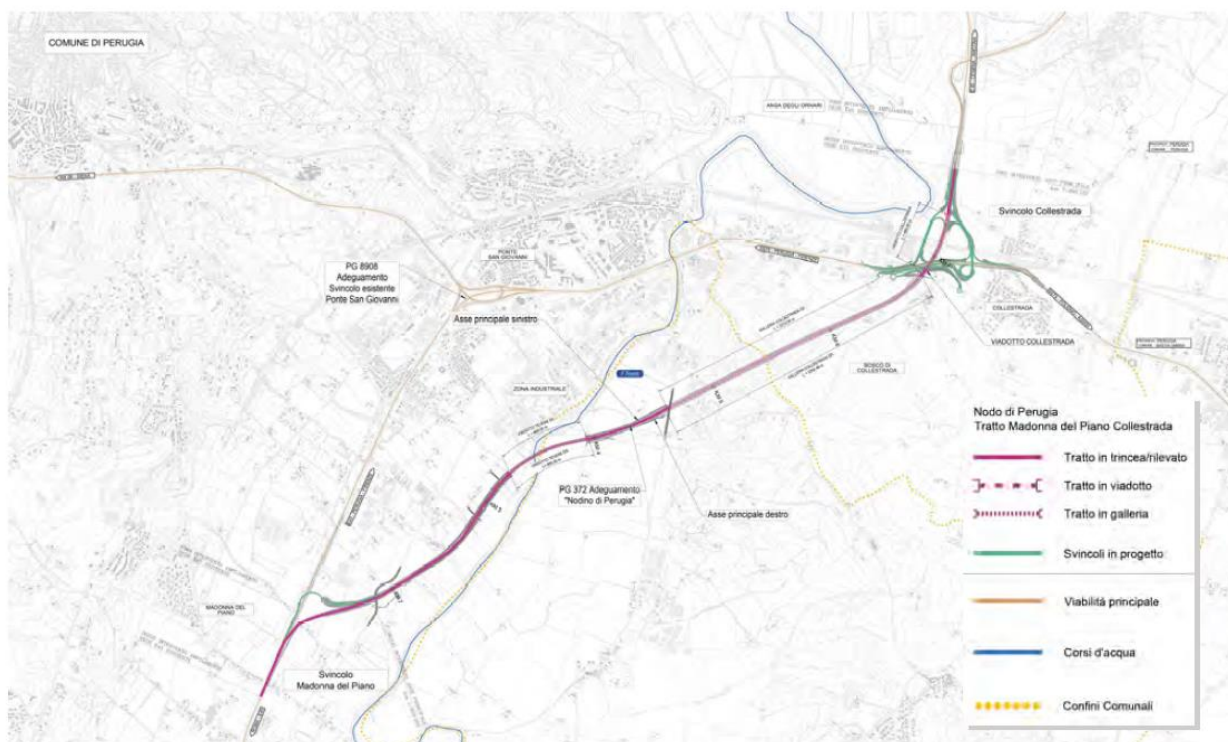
Localizzazione del Progetto Definitivo – Tratto Madonna del Piano – Collestrada su base CTR
